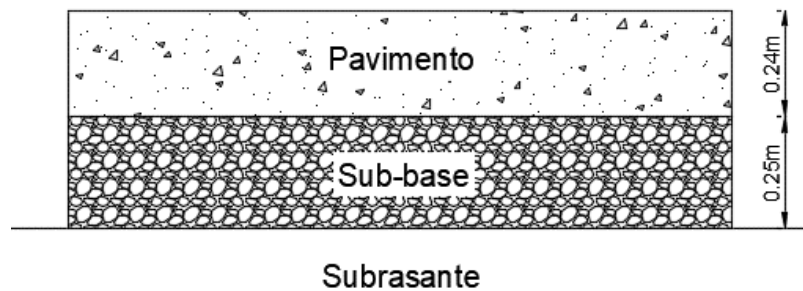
Paquete estructural. Fuente: autoría propia.
